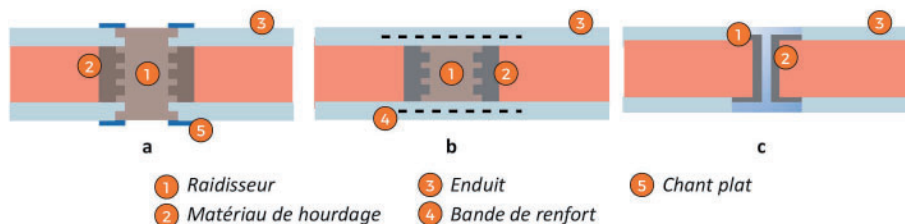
Exemples de raidisseurs (a et b : en bois, c : métallique)
